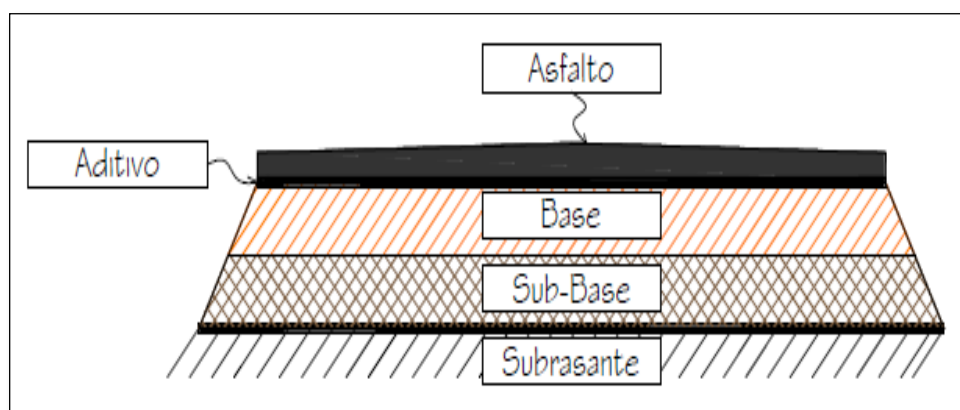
Sección Típica transversal del pavimento semi rígido
